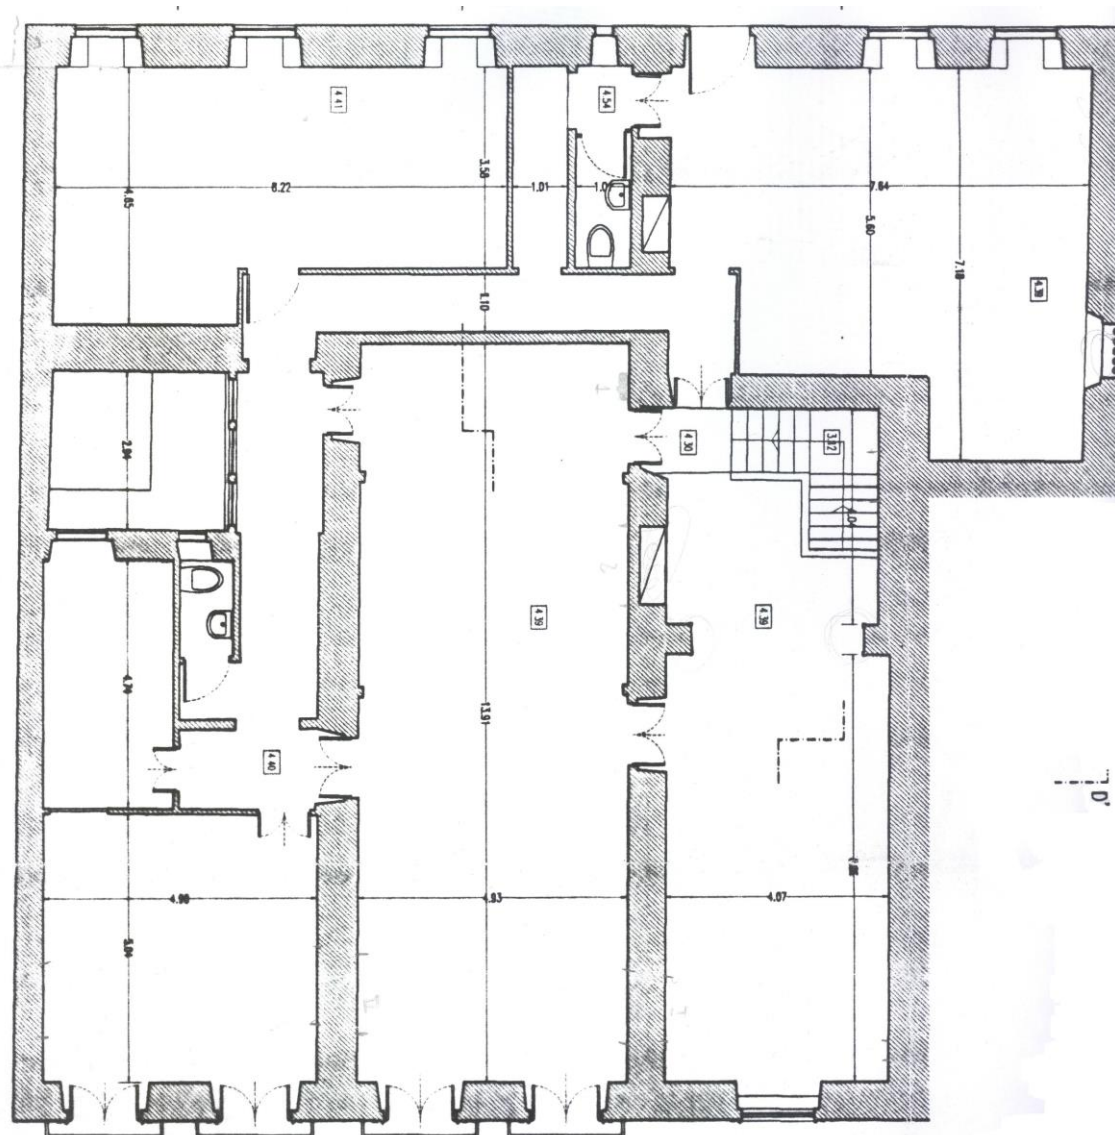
Planta do piso 1 do palacete. (PINTO, 2005, Anexo I)
